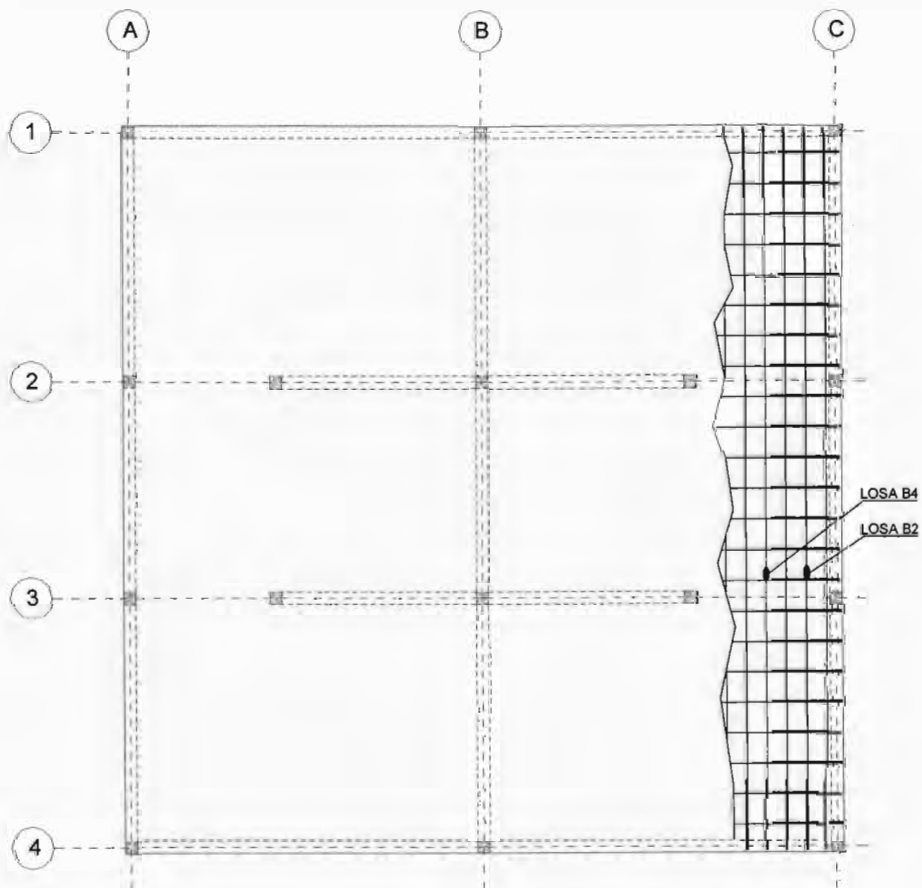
Distribución de deformímetros en la losa del primer piso
